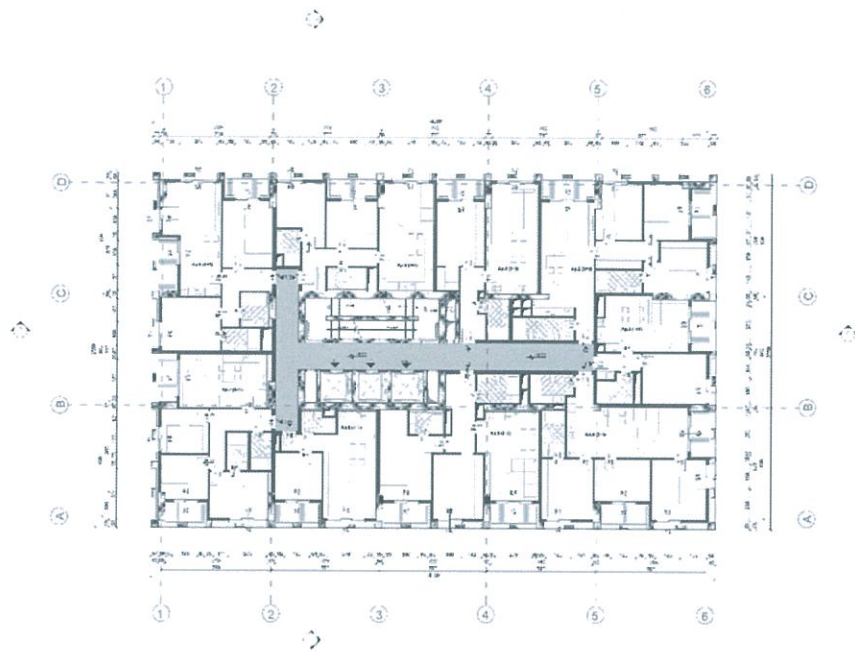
Planimetria e katit +4, +6, +8, +10, +12, +14
